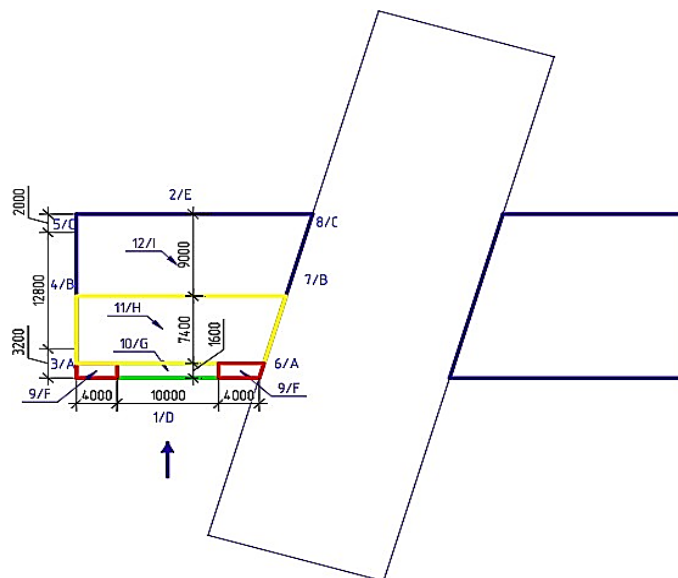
Схема прикладання вітрового навантаження по осі У на будівлю на будівлю до позначки +8,000 м
